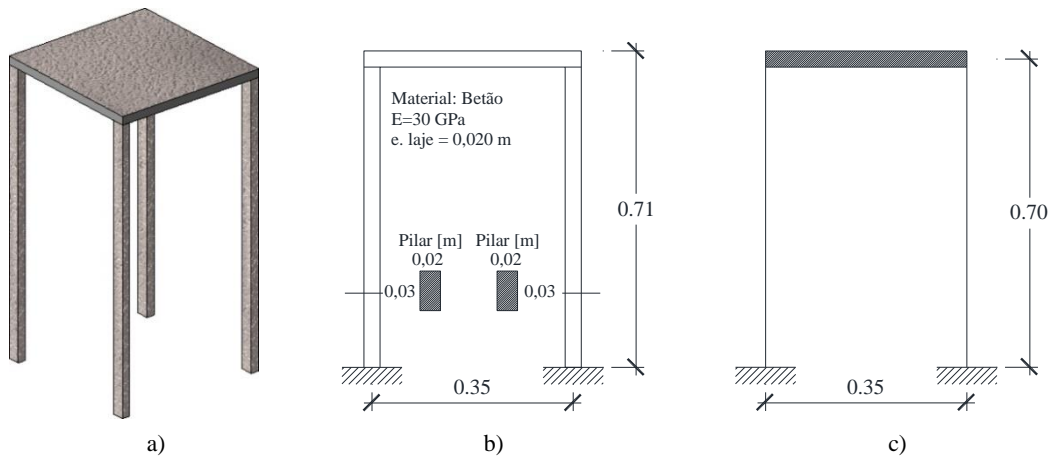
a) Modelo físico da estrutura do edifício de 1 piso de betão armado; b) modelo plano; c) idealização estrutural plana.
